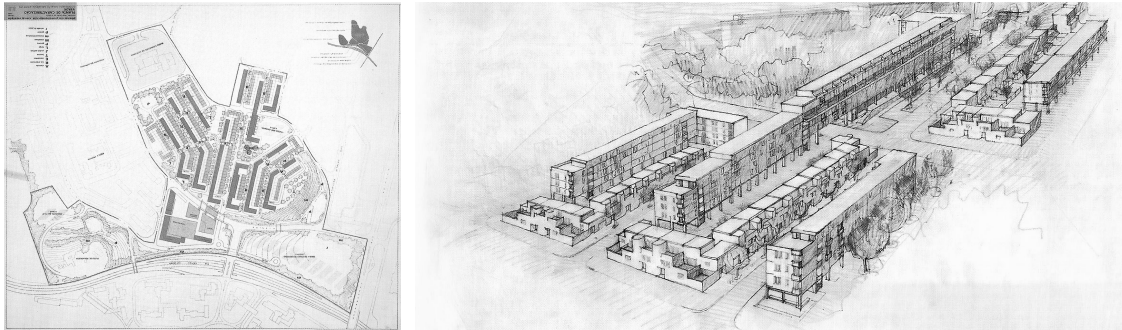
Bairro da EPUL no Restelo: planta de conjunto e perspectiva da proposta
